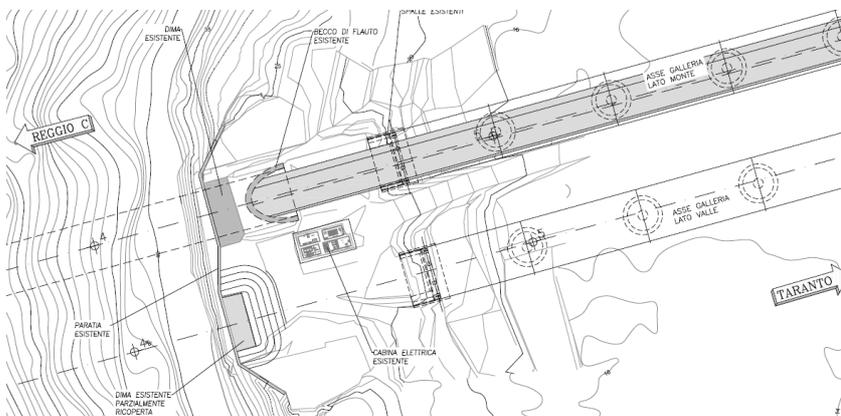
Galleria Palizzi-Stato di fatto – Lato TA
